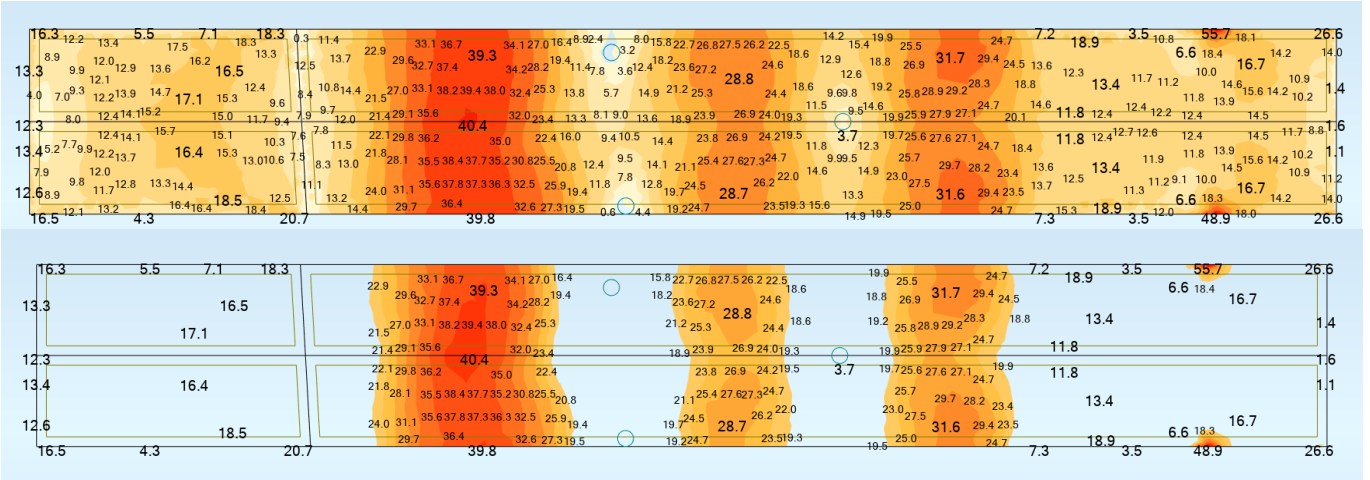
Armadura inferior longitudinal (abajo zona reforzada)
